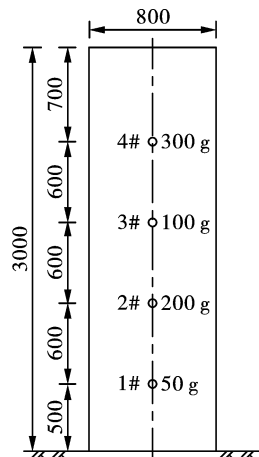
钢筋混凝土柱单孔爆破试验(单位:mm)
